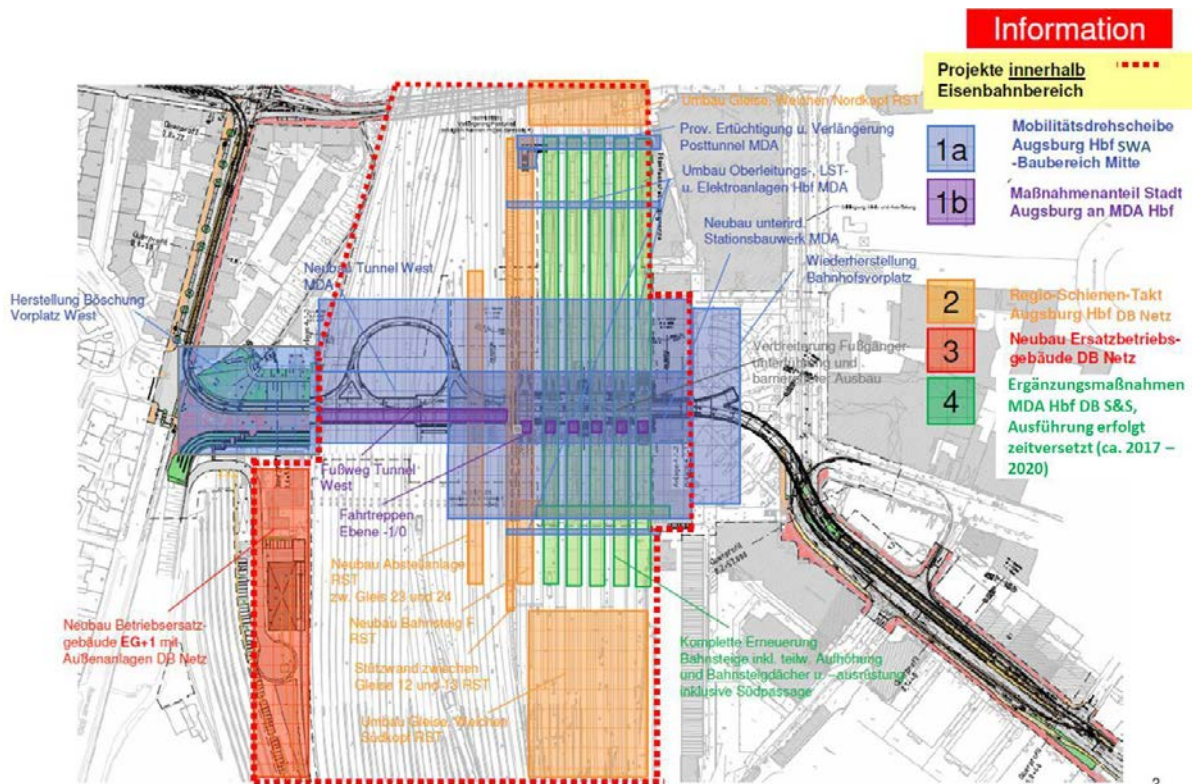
Augsburg - Lageplan Einzelprojekte
